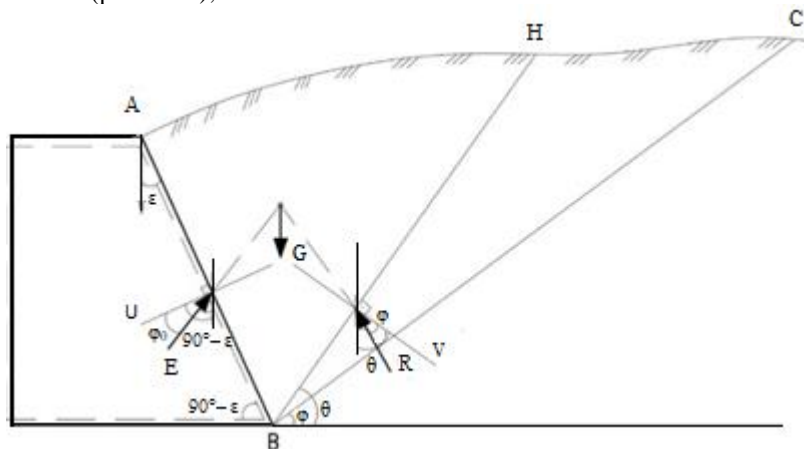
Схема к определению давления грунта E на грань стены АВ
